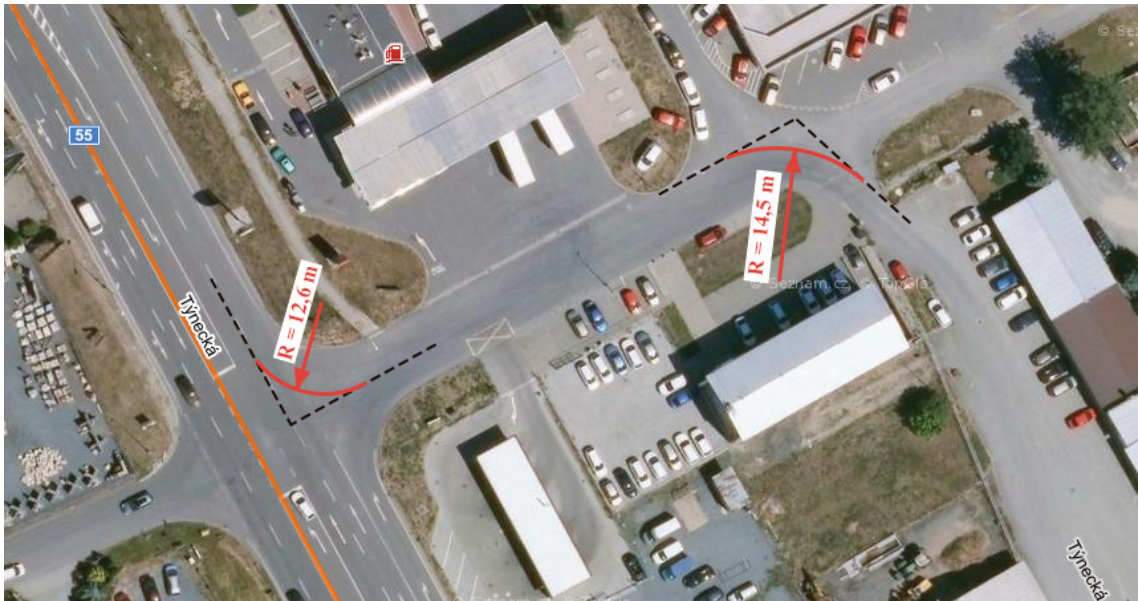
Trasa A (upraveno autorem) [1]
